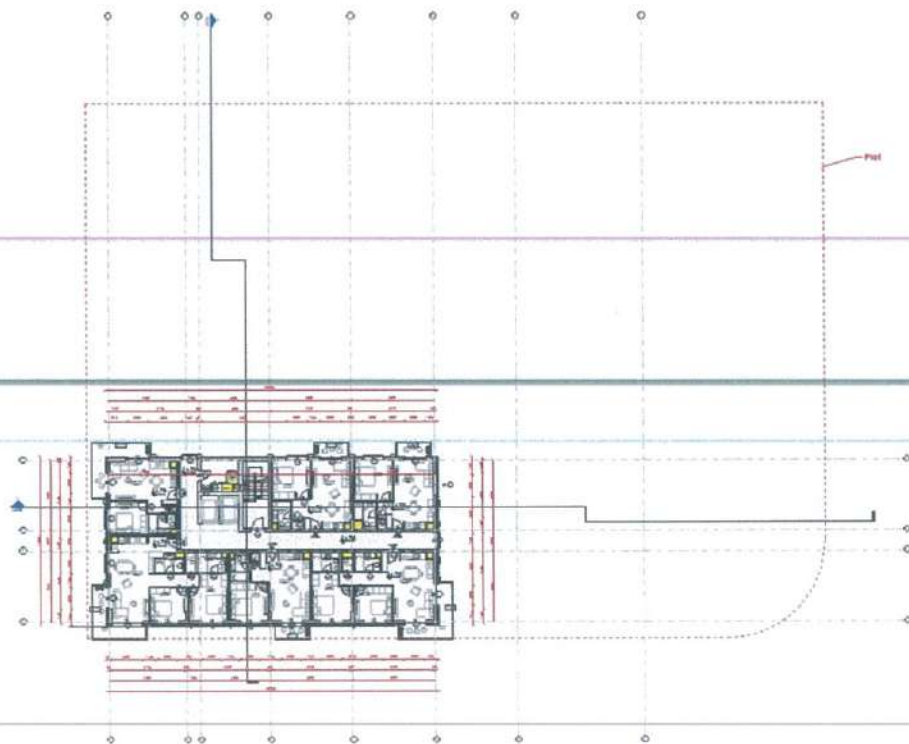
Planimetria e katit +7,+8,+9,+10,+11,+12
